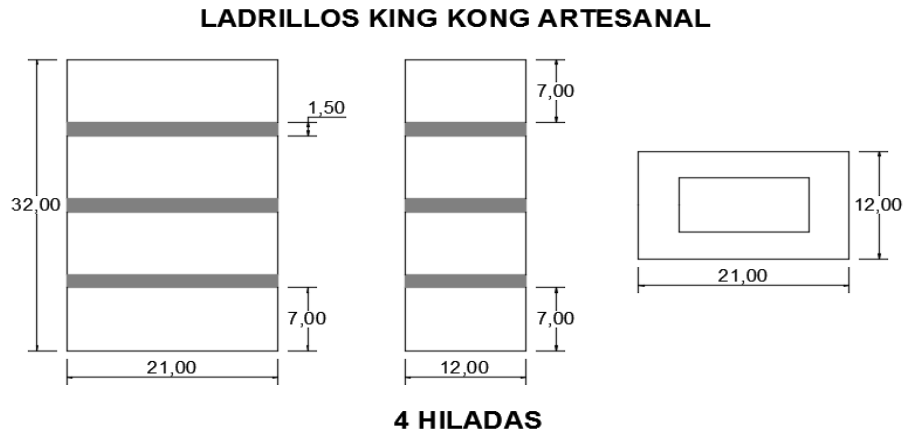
Geometría de pilas de albañilería con ladrillos artesanales.
